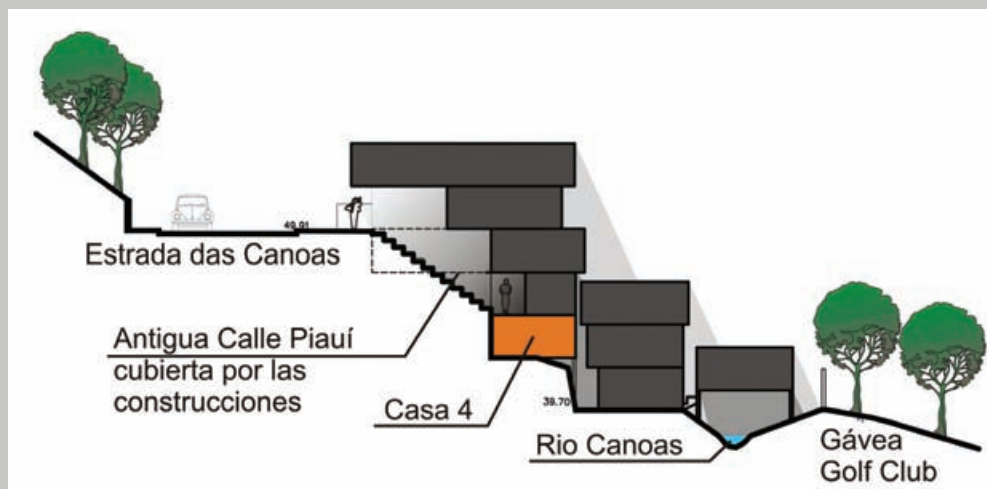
Corte esquemático de la antigua Calle Piauí, escalera pública, actualmente cubierta y cerrada por construcciones. Fuente: autora/2007.
